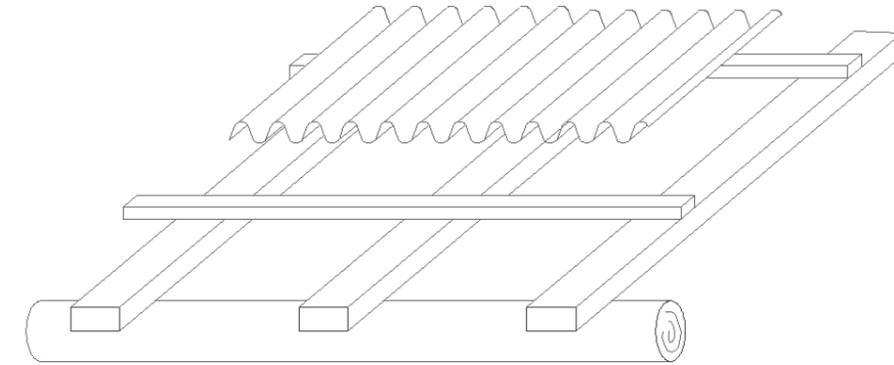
Detalle cubierta acabado con placas de fibrocemento. Fuente: autor propio
